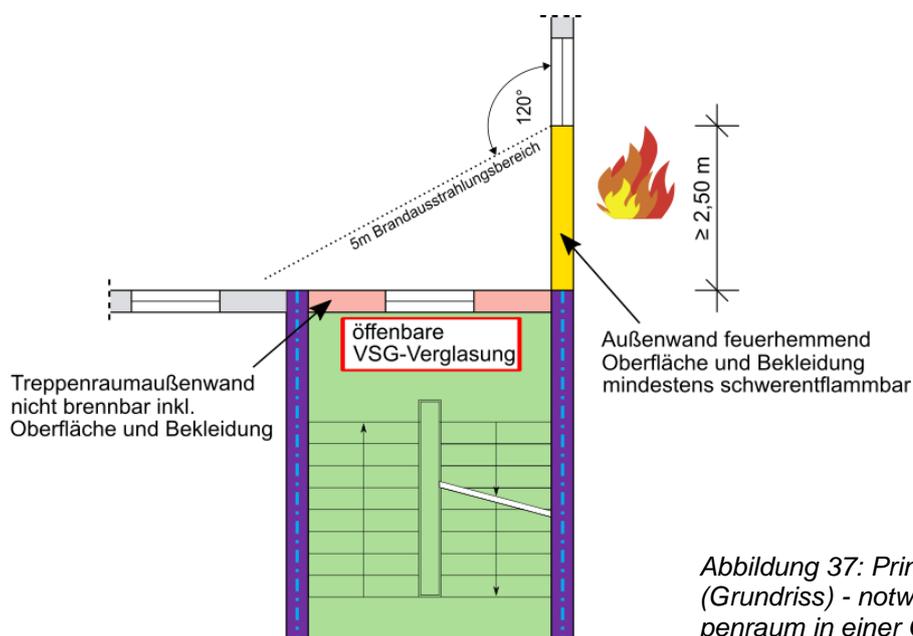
Prinzipskizze (Grundriss) - notwendiger Treppenraum in einer Gebäudeinnenecke
